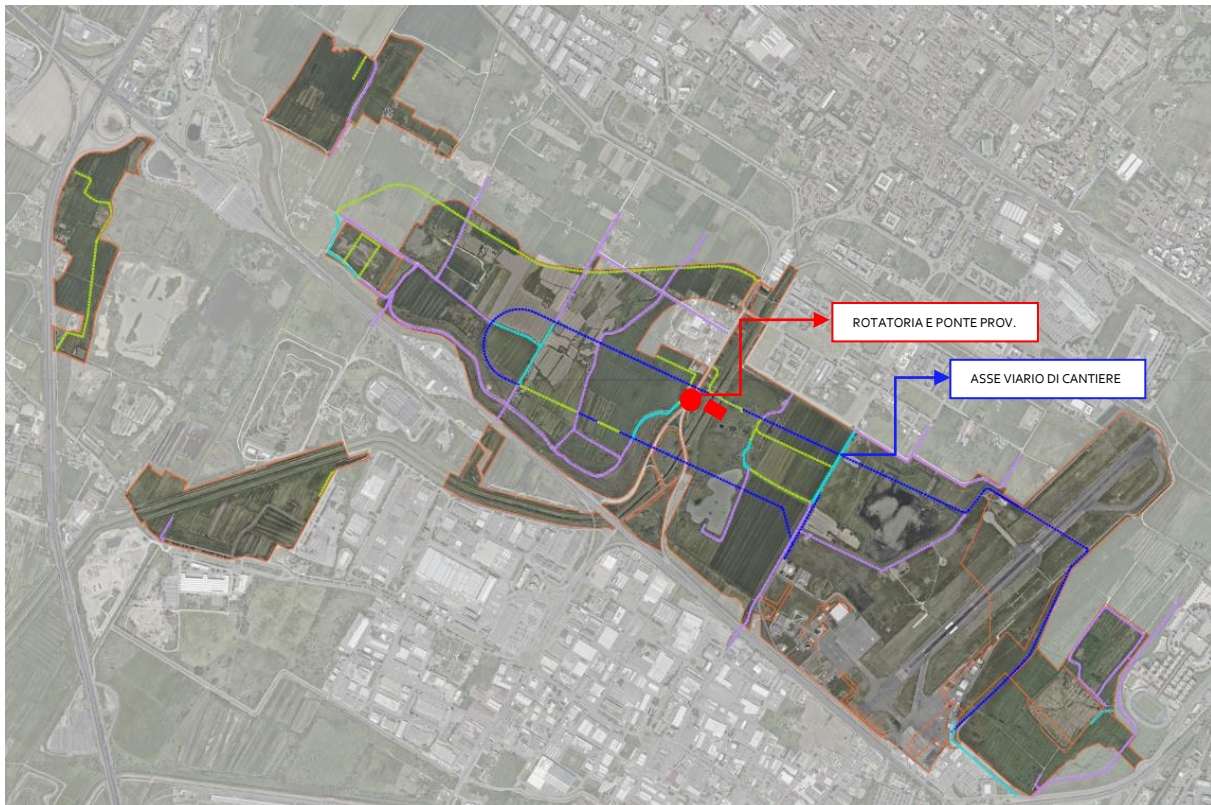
Planimetria di cantierizzazione: viabilità di cantiere
